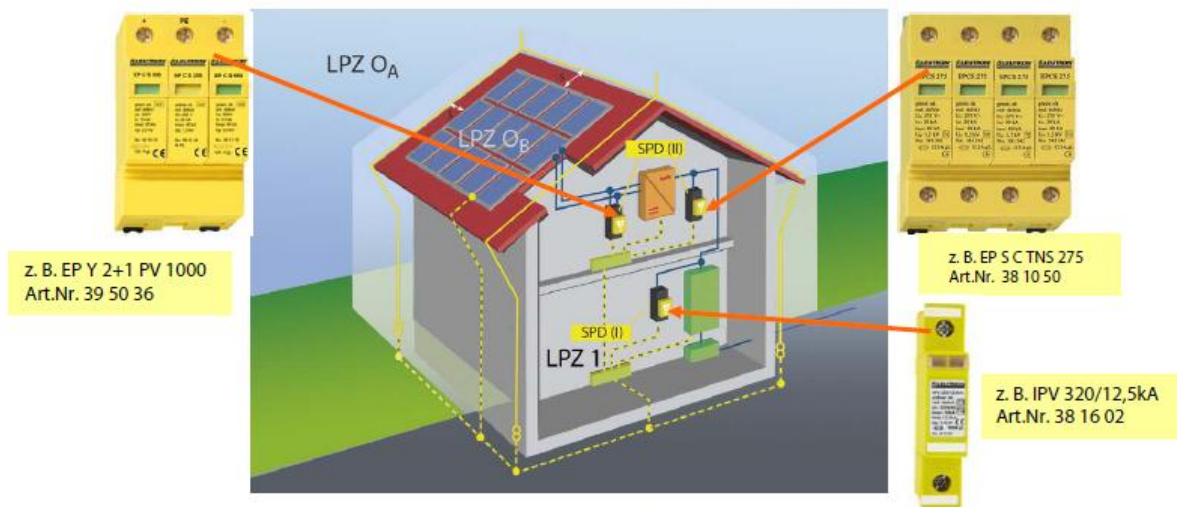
Gebäudeinstallation mit äußerer Blitzschutzanlage und Einhaltung des Trennungsabstandes
